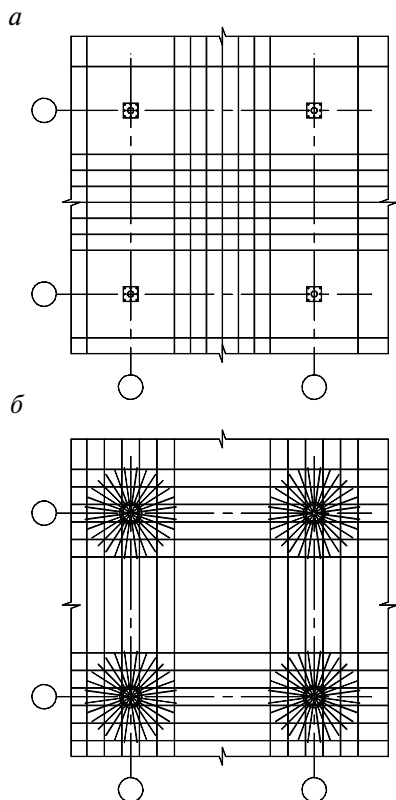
Схема сопряжения радиальной рабочей арматуры плоской плиты перекрытия с традиционной рабочей арматурой:
